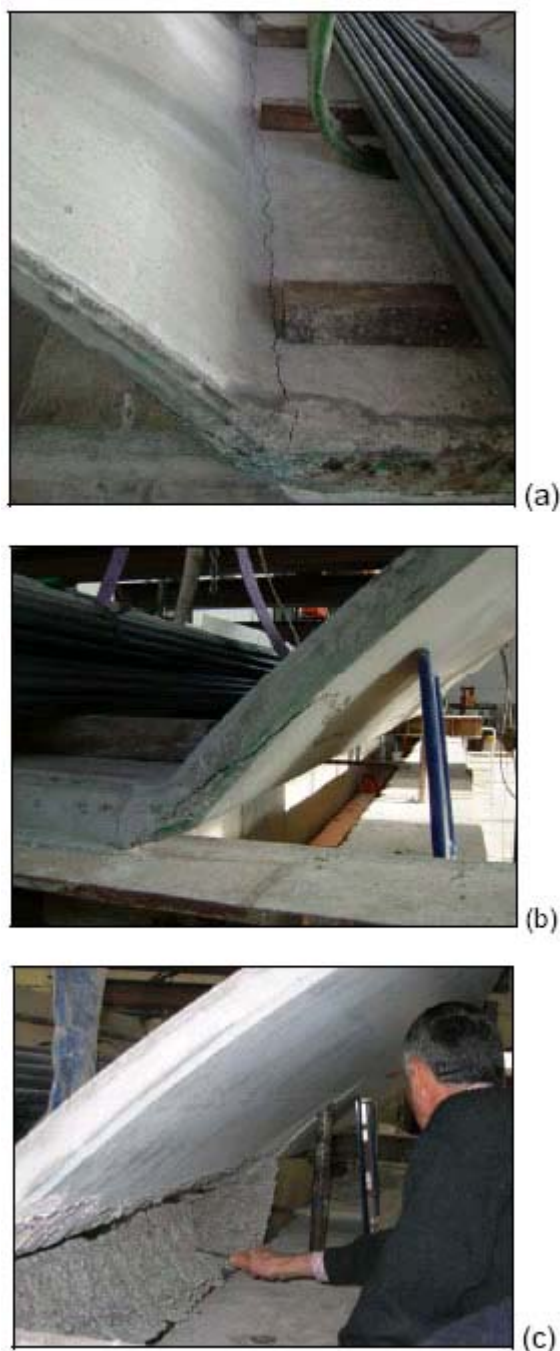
(a) Prova 3: fessura longitudinale, a rottura, all'estradosso del tegolo in prossimità dell'appoggio; (b) Prova 2: fessura di "spalling" del calcestruzzo
